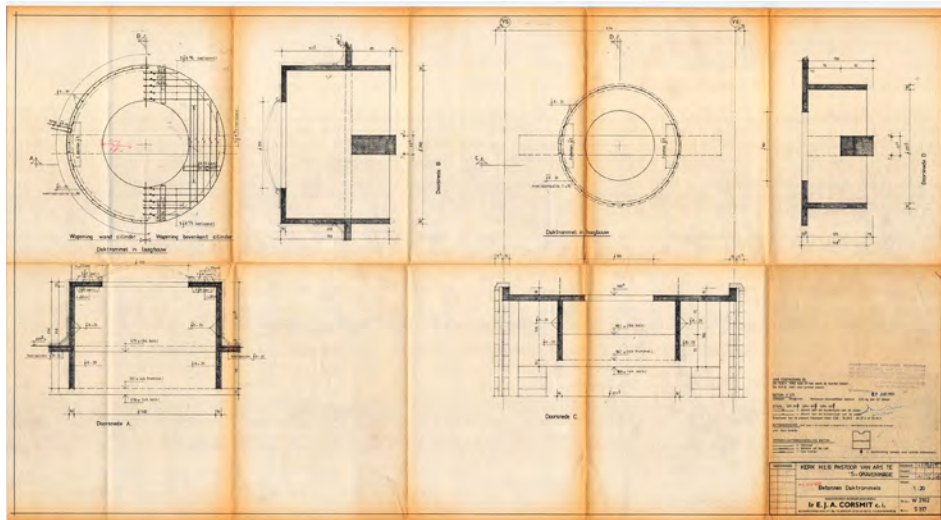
Sección constructiva perteneciente al juego de planos de la ingeniería, con fecha 27/08/1968. (Plano de la ingeniería Corsmit)
